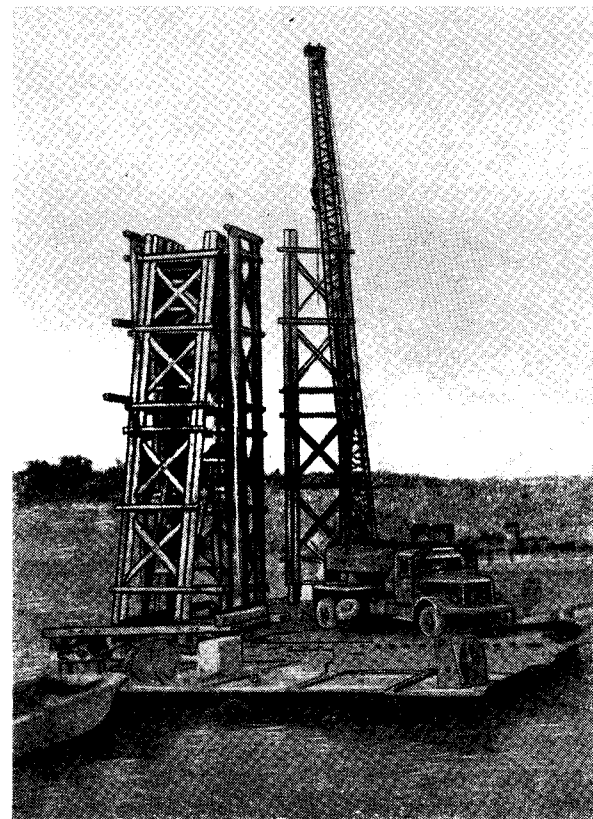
Монтаж сборной деревянной опоры из бревен отдельными рамами
